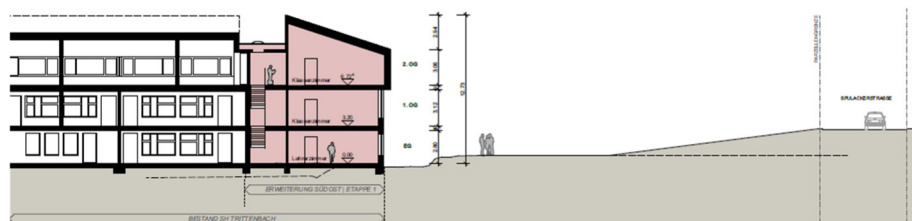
Disposition 02 | Gebäudeschnitt B-B
